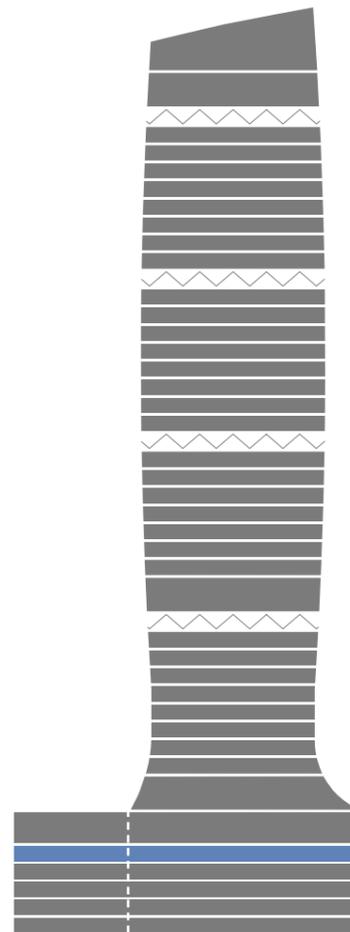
Grundriss 1. Untergeschoss (eigener Plan)
